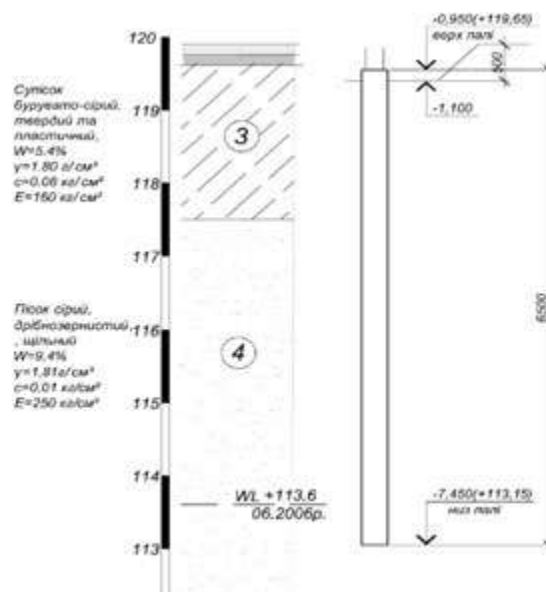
Рекомендації стосово влаштування коротких пал під окомо-стячі фундаментні туми каркасу будівлі
